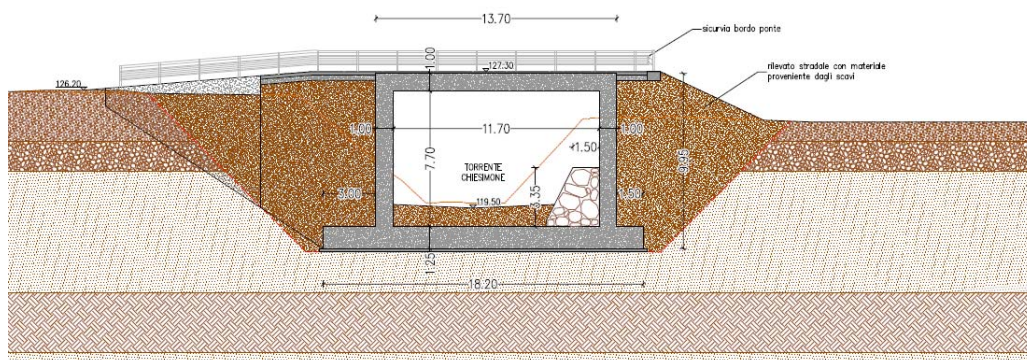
Sezione tipo opera di attraversamento del torrente Chiesimone
